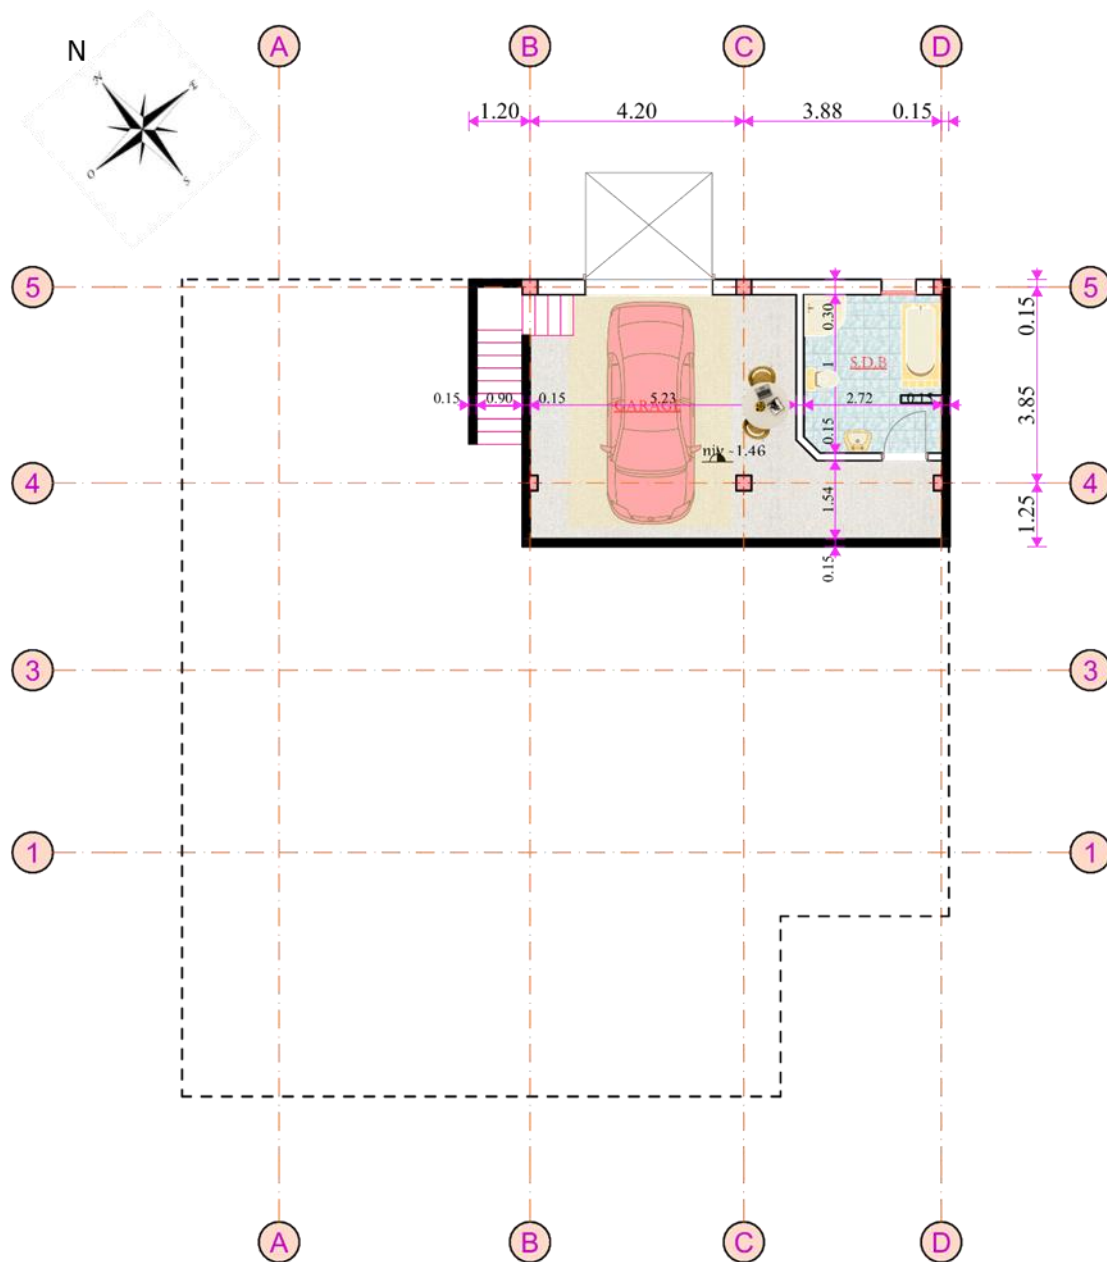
Plan Sous-Sol F4 ech 1/100.
